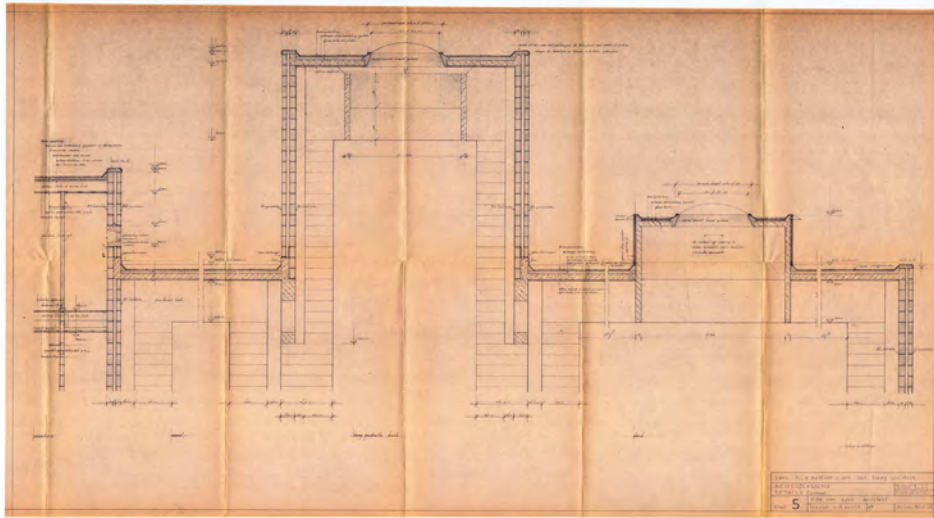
Detalle constructivo en planta de las diferentes secciones que los tramos de muro centrales experimentan en su desarrollo en altura. (Plano de la ingeniería Corsmit).
